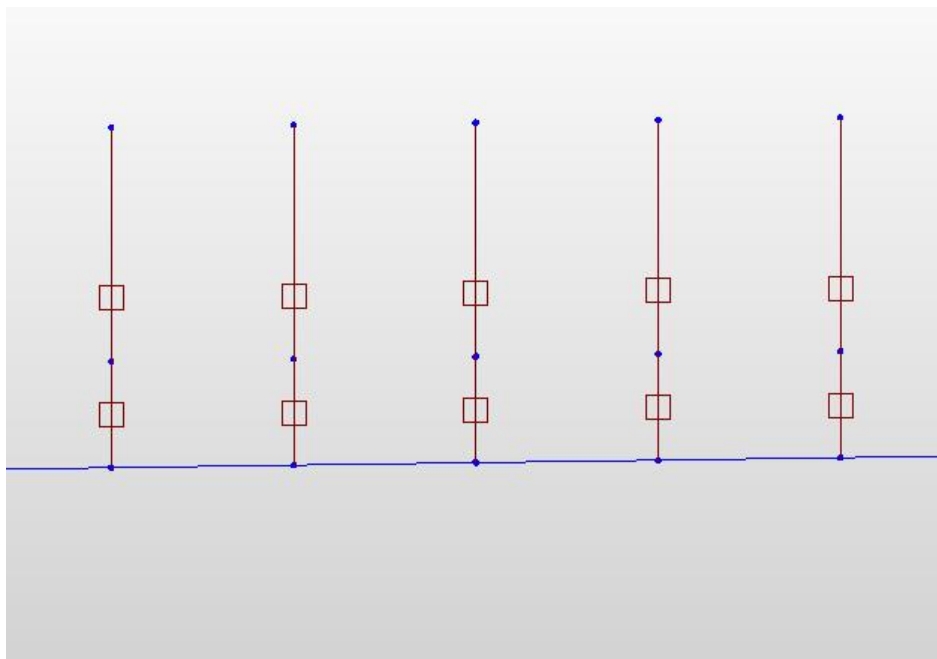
Modellazione della disposizione delle masse lungo l'altezza dell'impalcato
